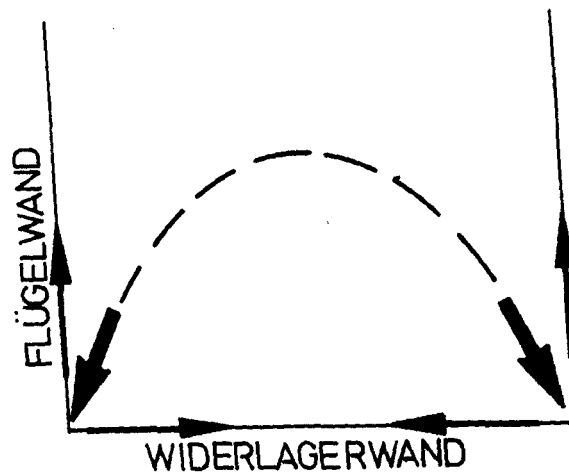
Aufnahme des Gewölbeschubes durch Widerlager- und Flügelwand (Horizontal-schnitt)
